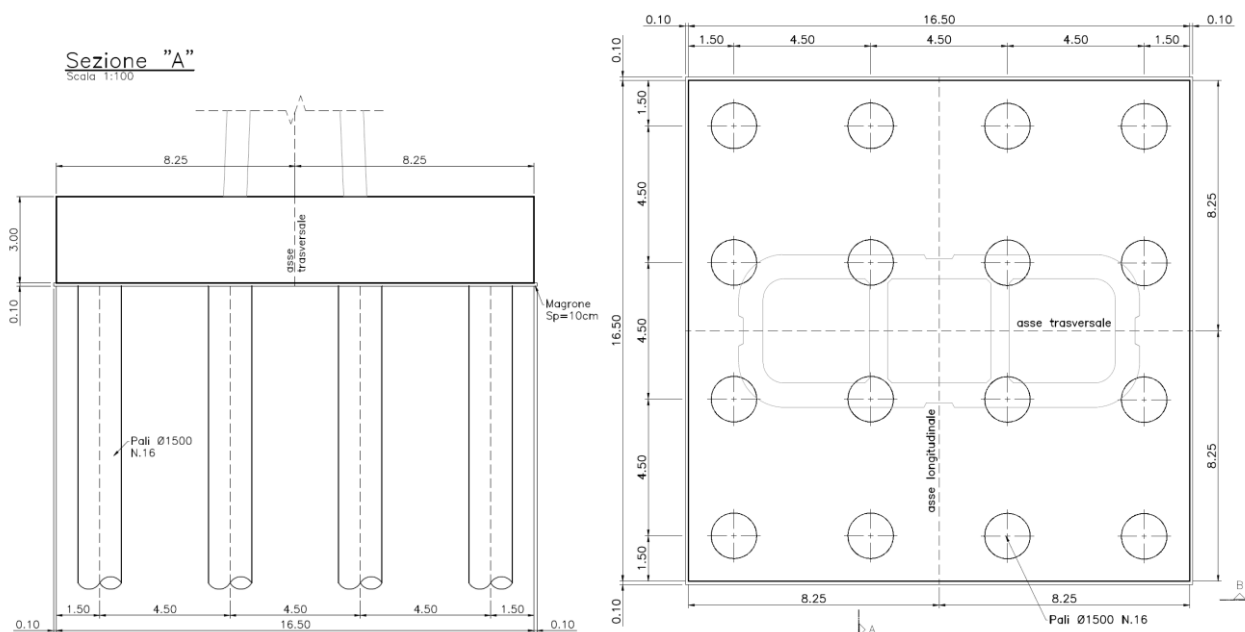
stralcio della carpenteria pila e fondazione su n° 16 pali
